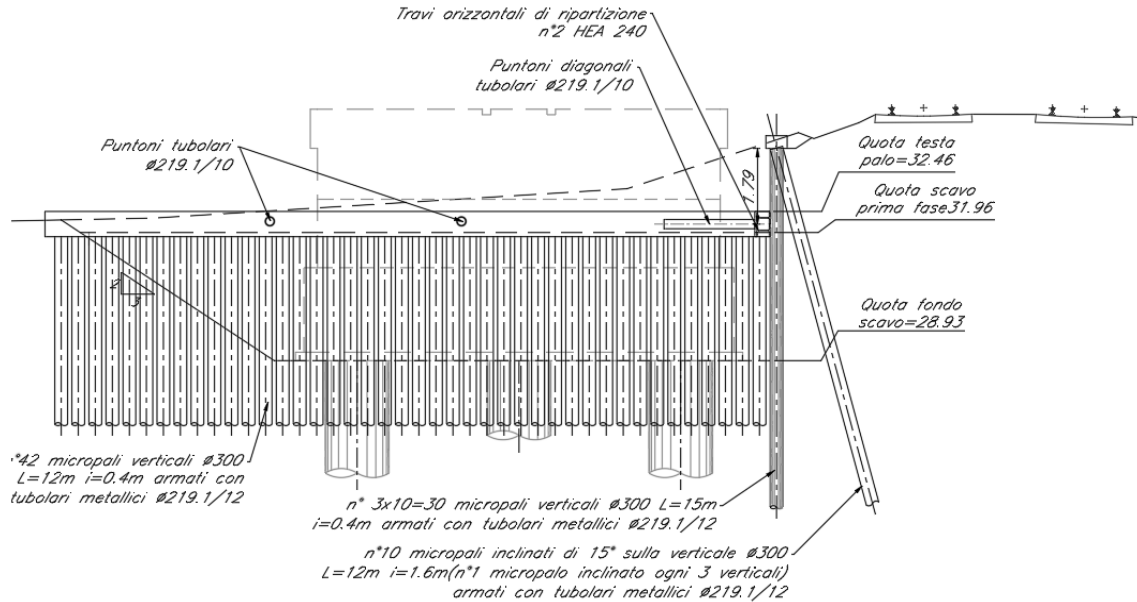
Sezione Opere Provisionali Spalla A
